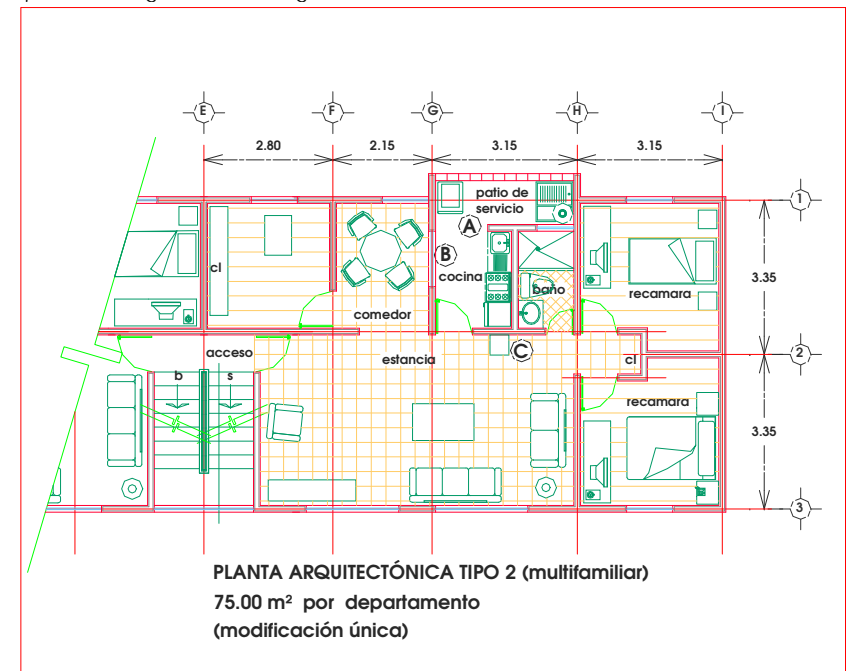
Planta arquitectónica tipo II modificaciones únicas
